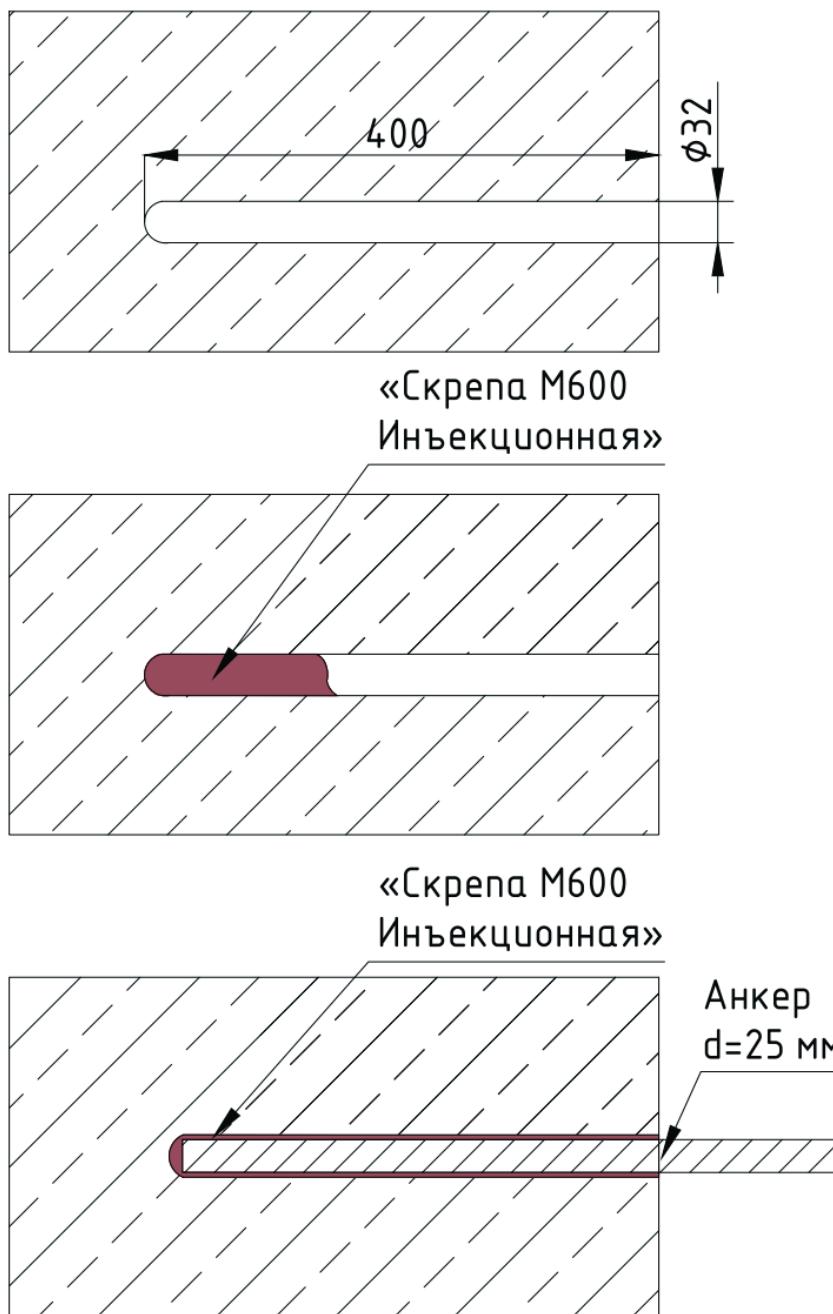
Схема закрепления анкера в строительной конструкции
